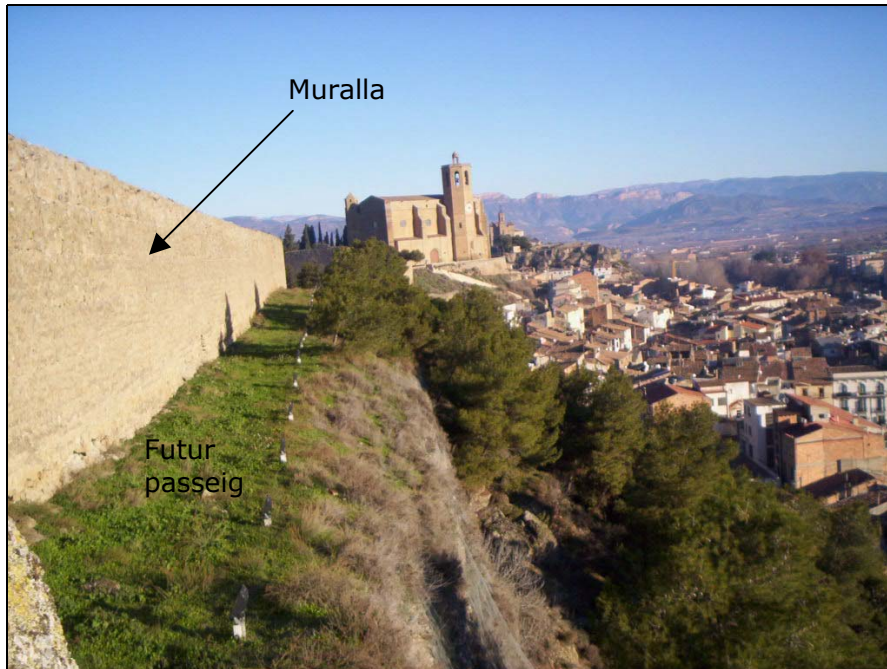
Imatge d'una de la zona posterior adjunta a la muralla.
